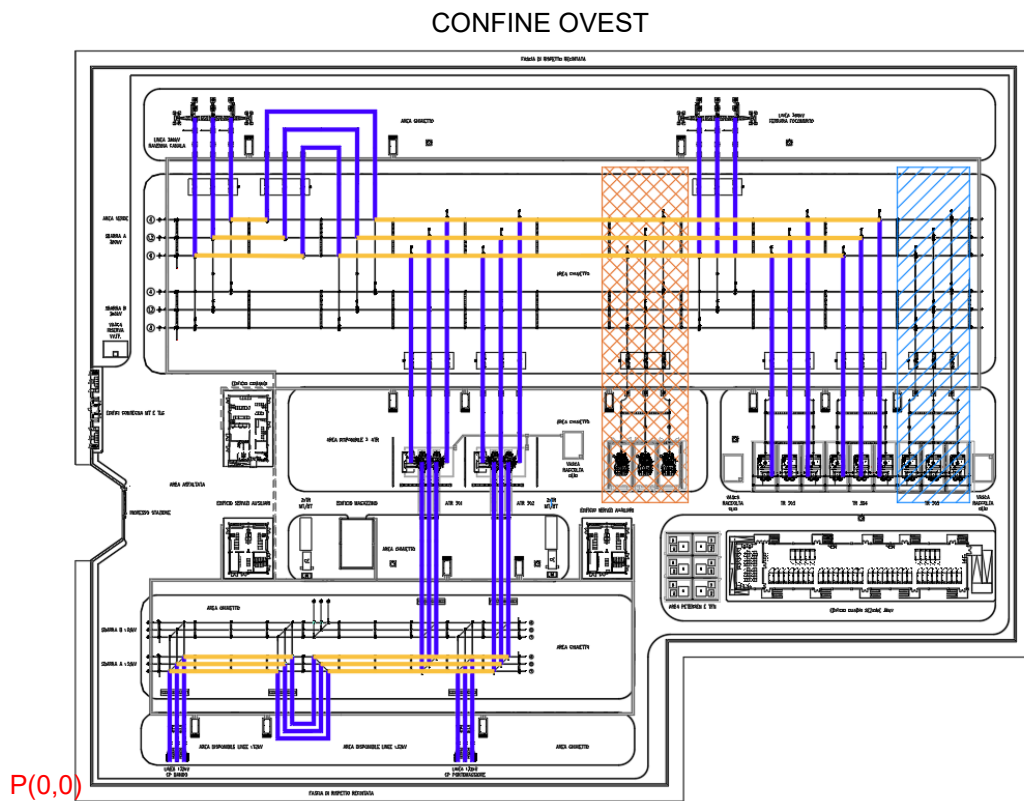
Schematizzazione degli elementi attivi all'interno della planimetria
